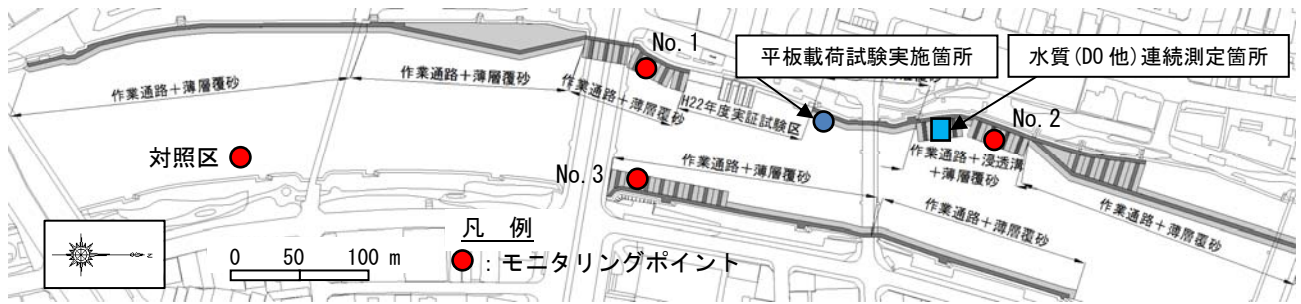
大規模実証試験施工平面図および調査箇所<sup>2)</sup>
